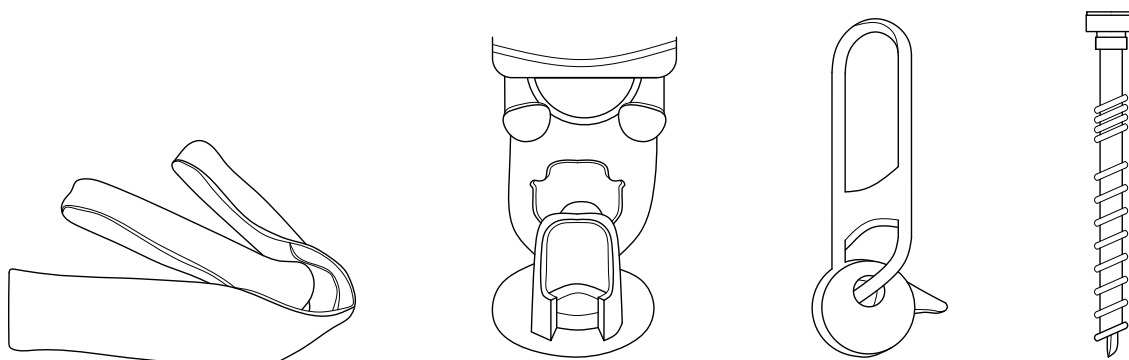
Tipos de anclajes para izaje de elementos y elementos
